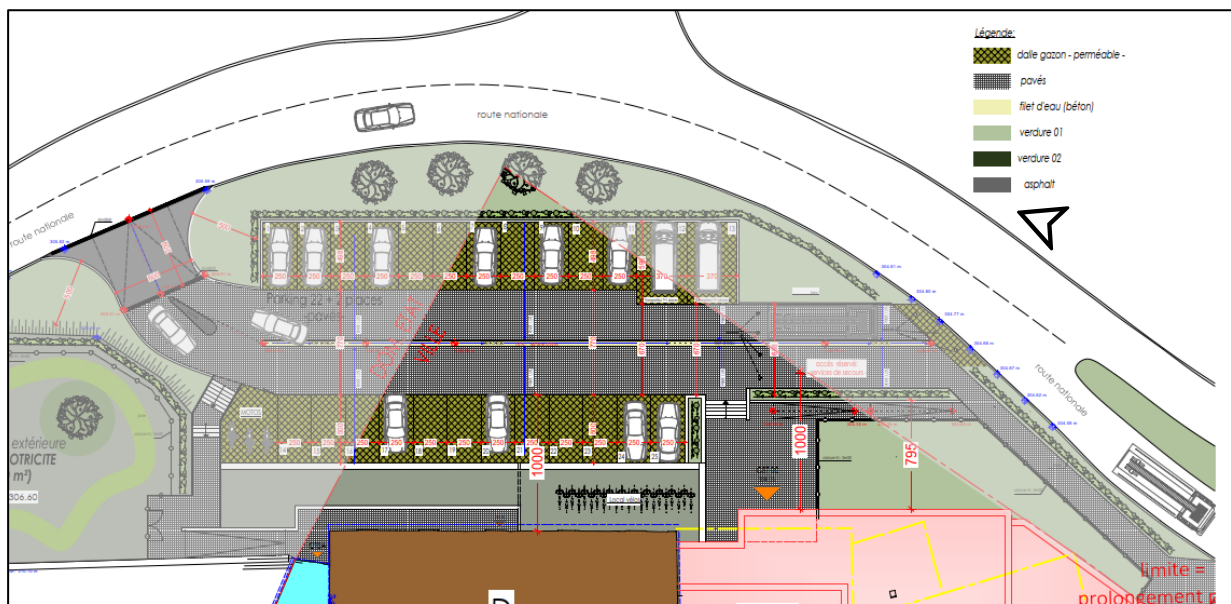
Plan d'implantation (Vandermeeren Architectes 2024)
